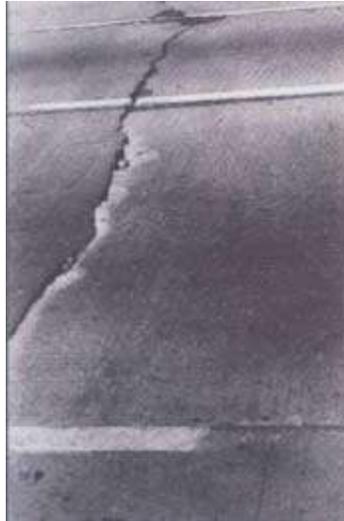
Escalonamiento de Juntas y Grietas
